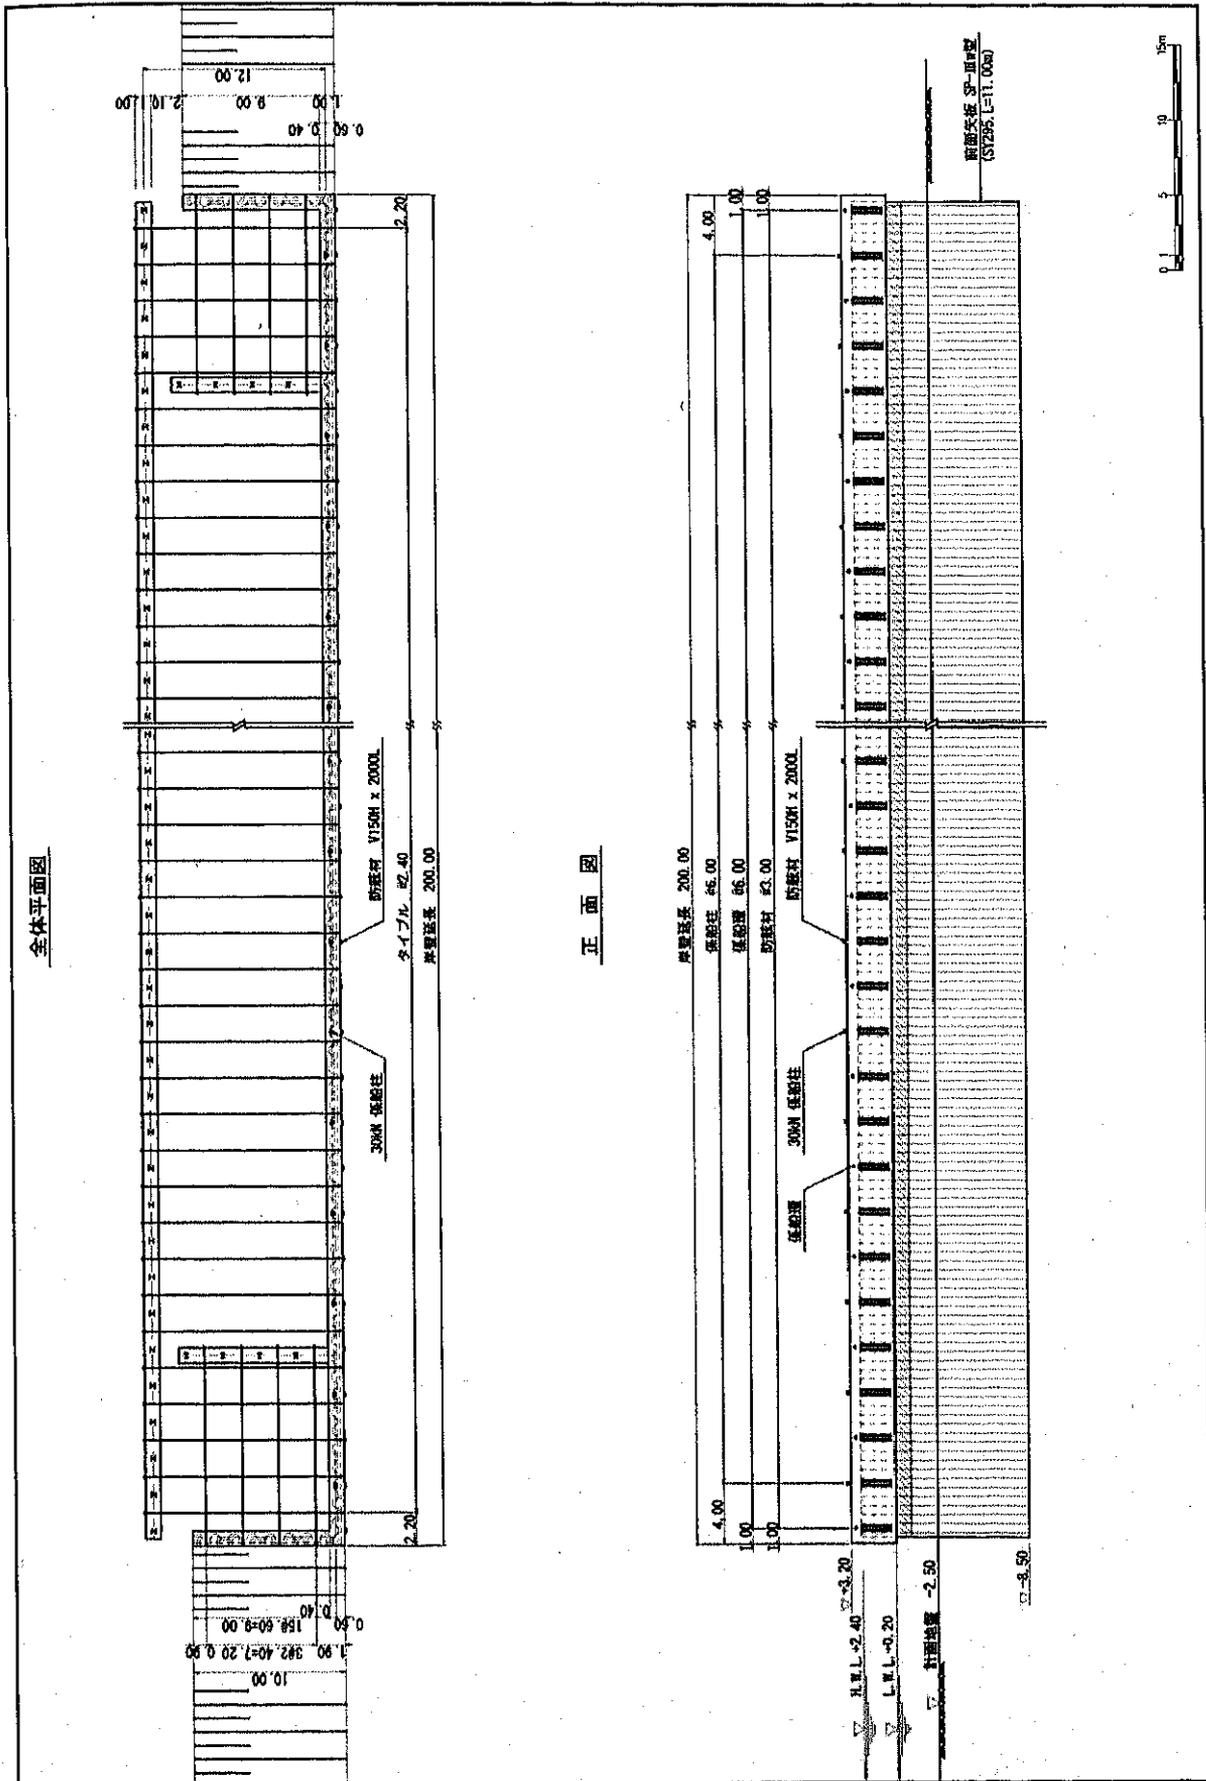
(17) 埠頭（岸壁）の平面図・正面図
